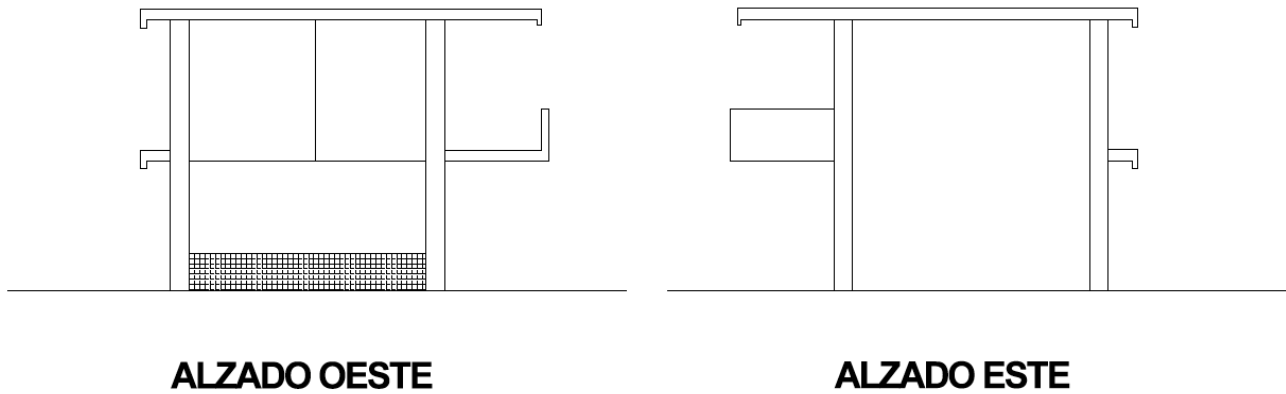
Alzado Este y Oeste del Edificio C del campus ITESO.
